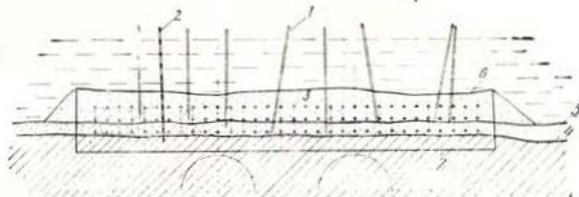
Фактическое расположение термометрических наблюдательных скважин в ледогрунтовой плите на дне канала (работа водолазов без освещения):
